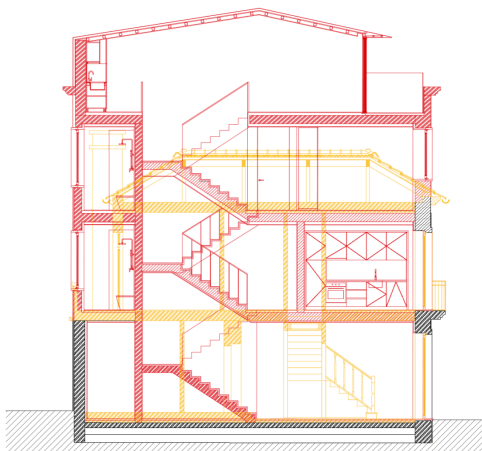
Corte Longitudinal (Proposta do Gabinete)
